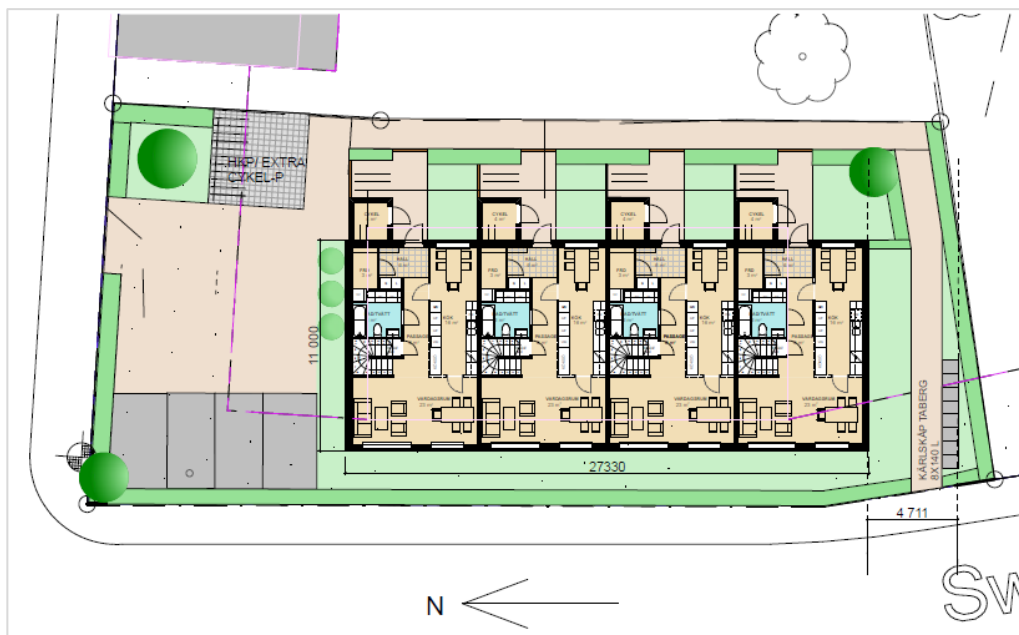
Illustrationsplan över planområdet som visar den föreslagna radhusbyggnaden. *Illustration: Archus
